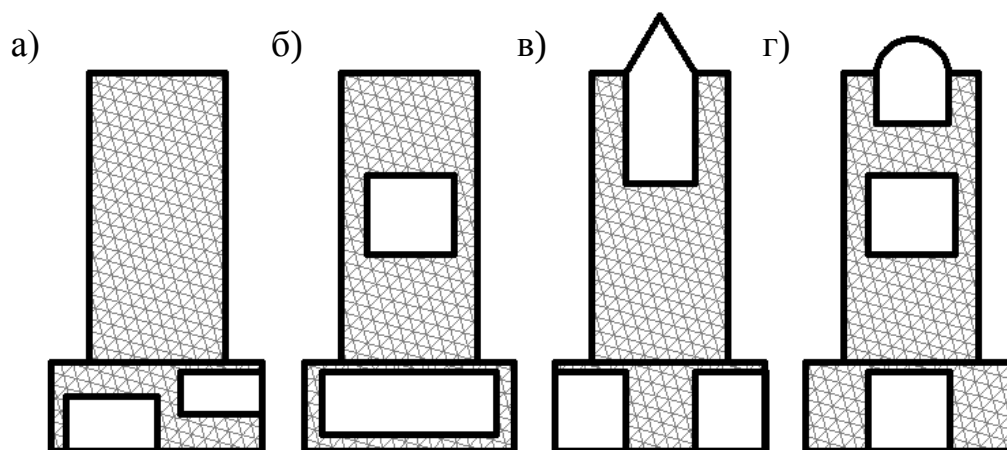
Варианты размещения зальных помещений в высотном здании:
